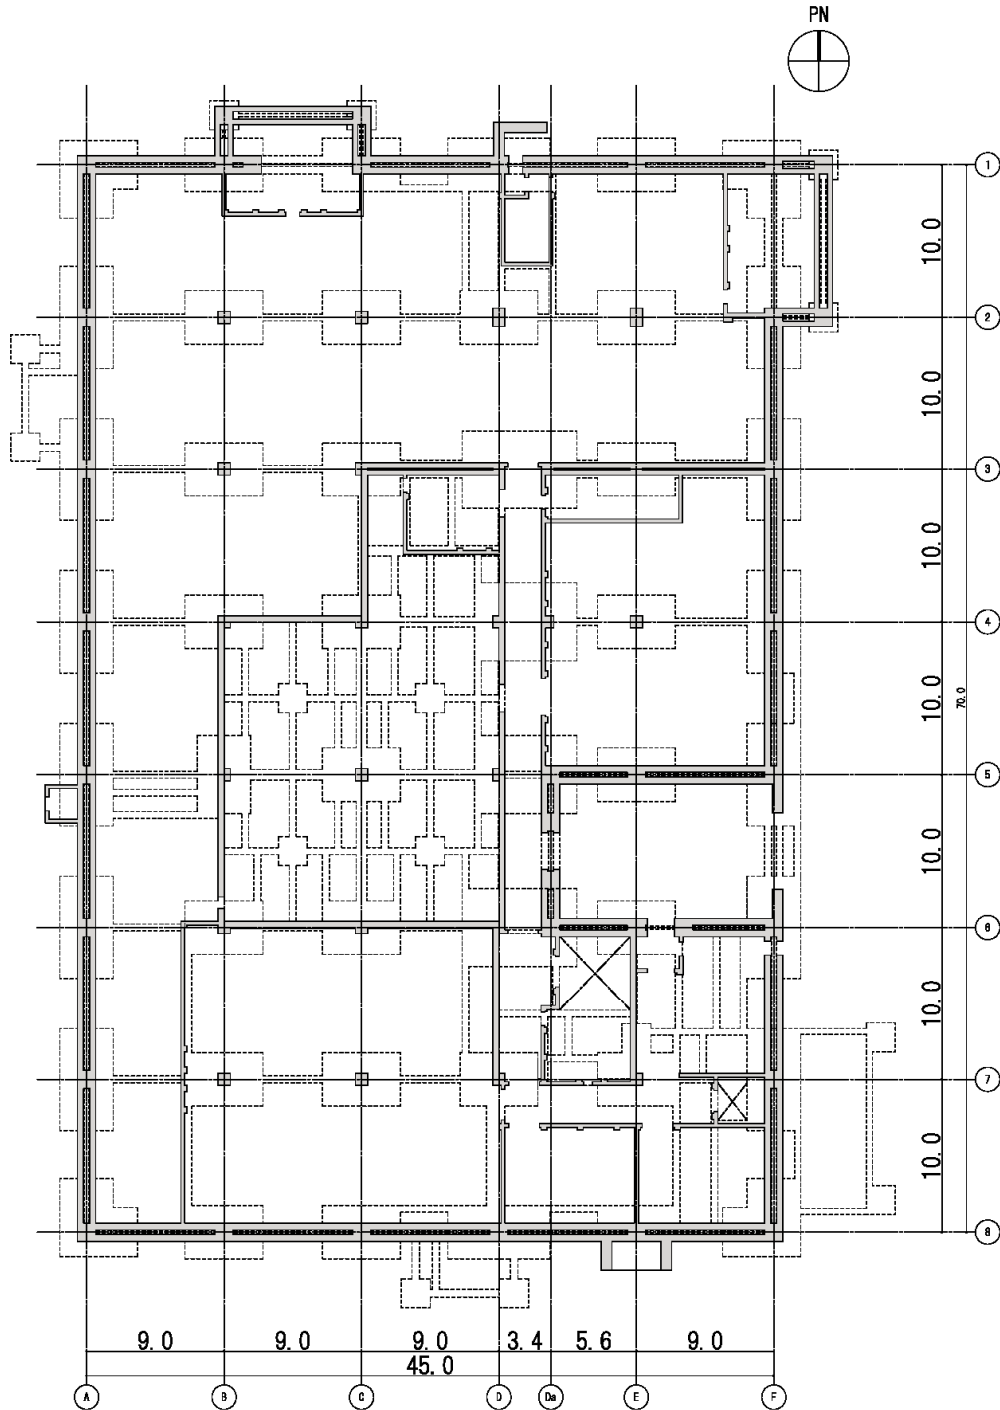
1階平面図 (G.L. +0.30) (単位 : m)
